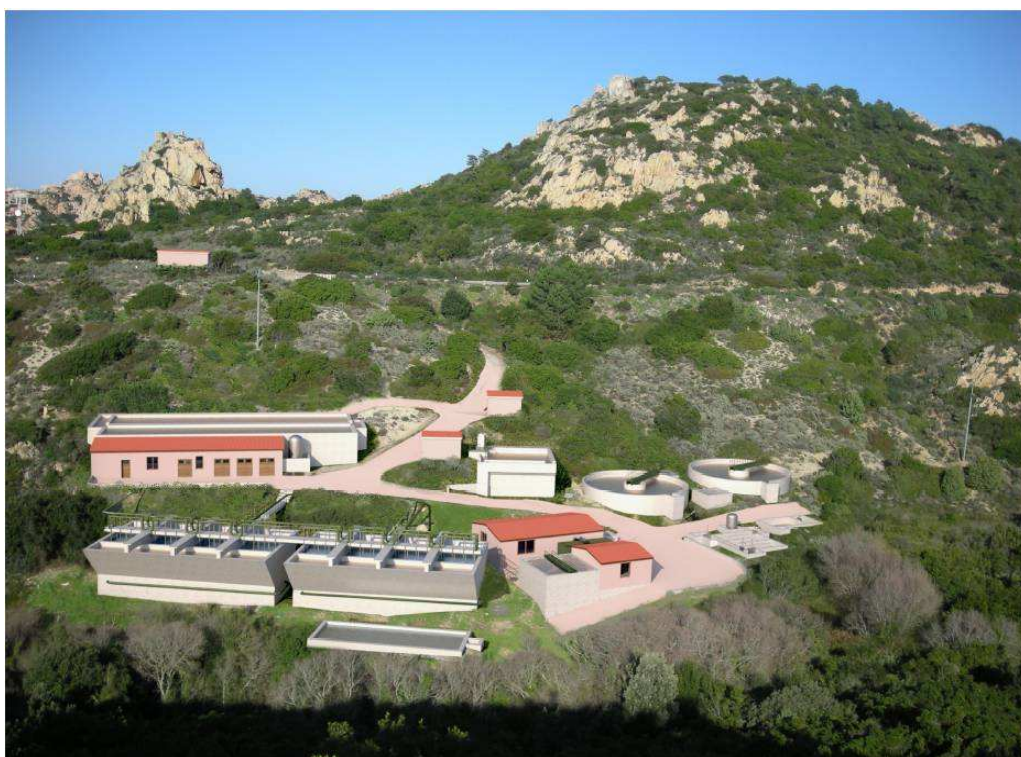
Fotoinserimento Impianto di Depurazione in proaetto
